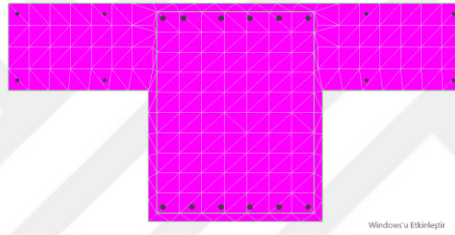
S11 kolonuna ait beton ve çelik modelleri.
